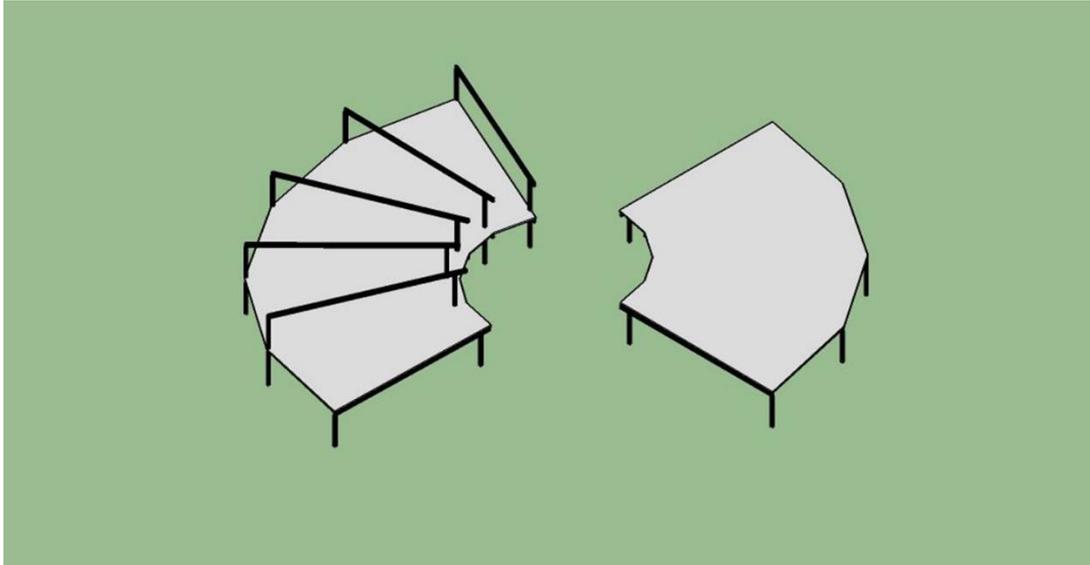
Configuración de pórticos en planta alta. Imagen propia
